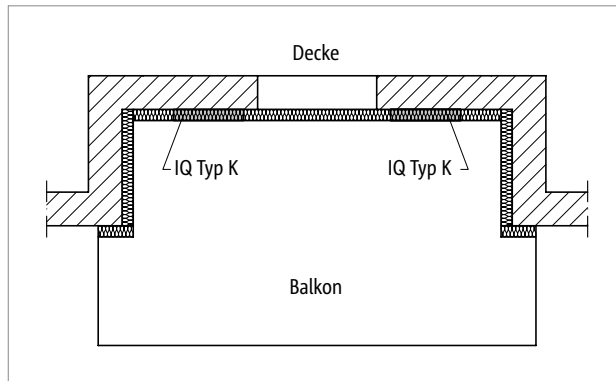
Schöck Isokorb® IQ Typ K-A/B: Balkon bei Fassadenrücksprung
